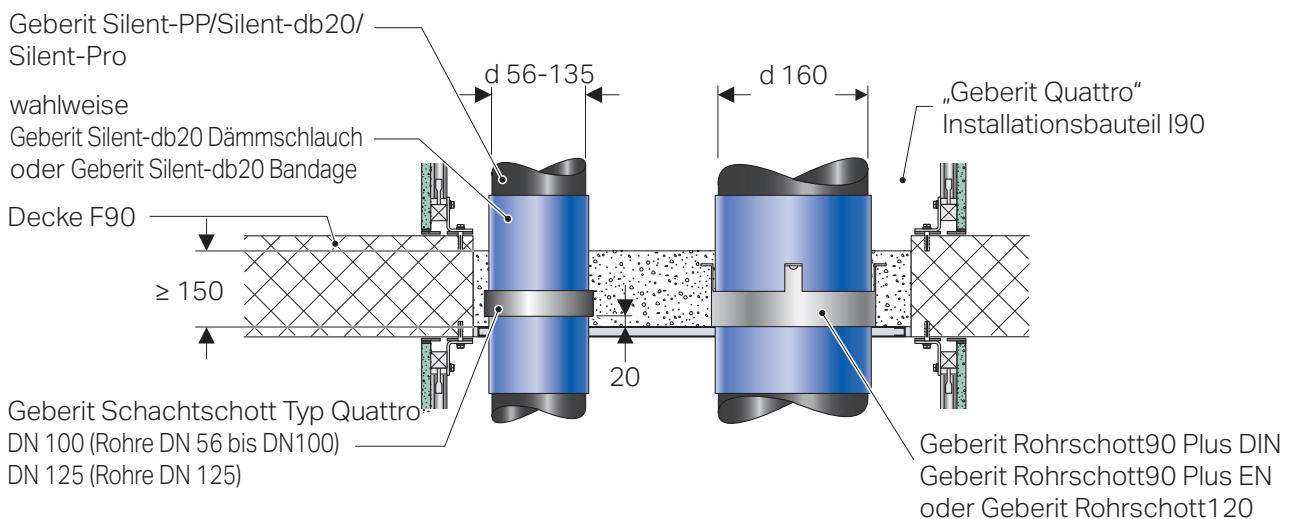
Deckendurchführungen im Geberit Quattro Installationsschacht mit Abwasserleitungen bis d 160 mm
